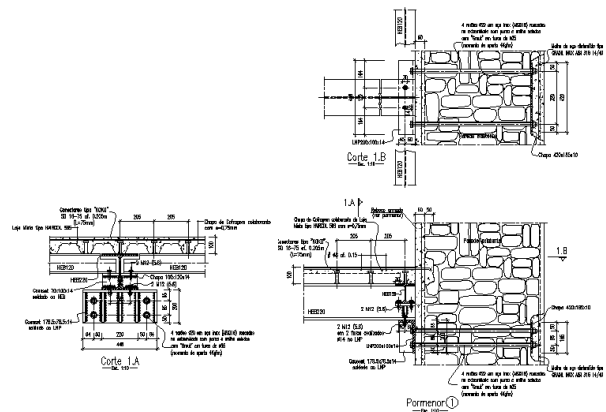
Pormenor de ligação dos pavimentos mistos à parede existente
